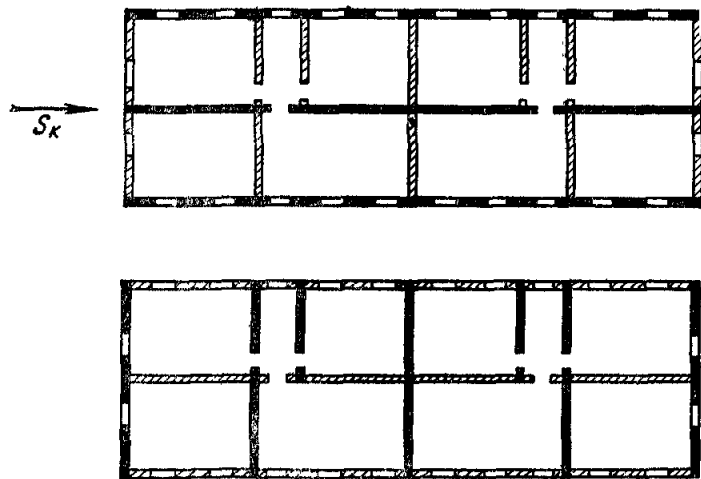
Схема распределения сейсмической нагрузки в здании с несущими стенами
